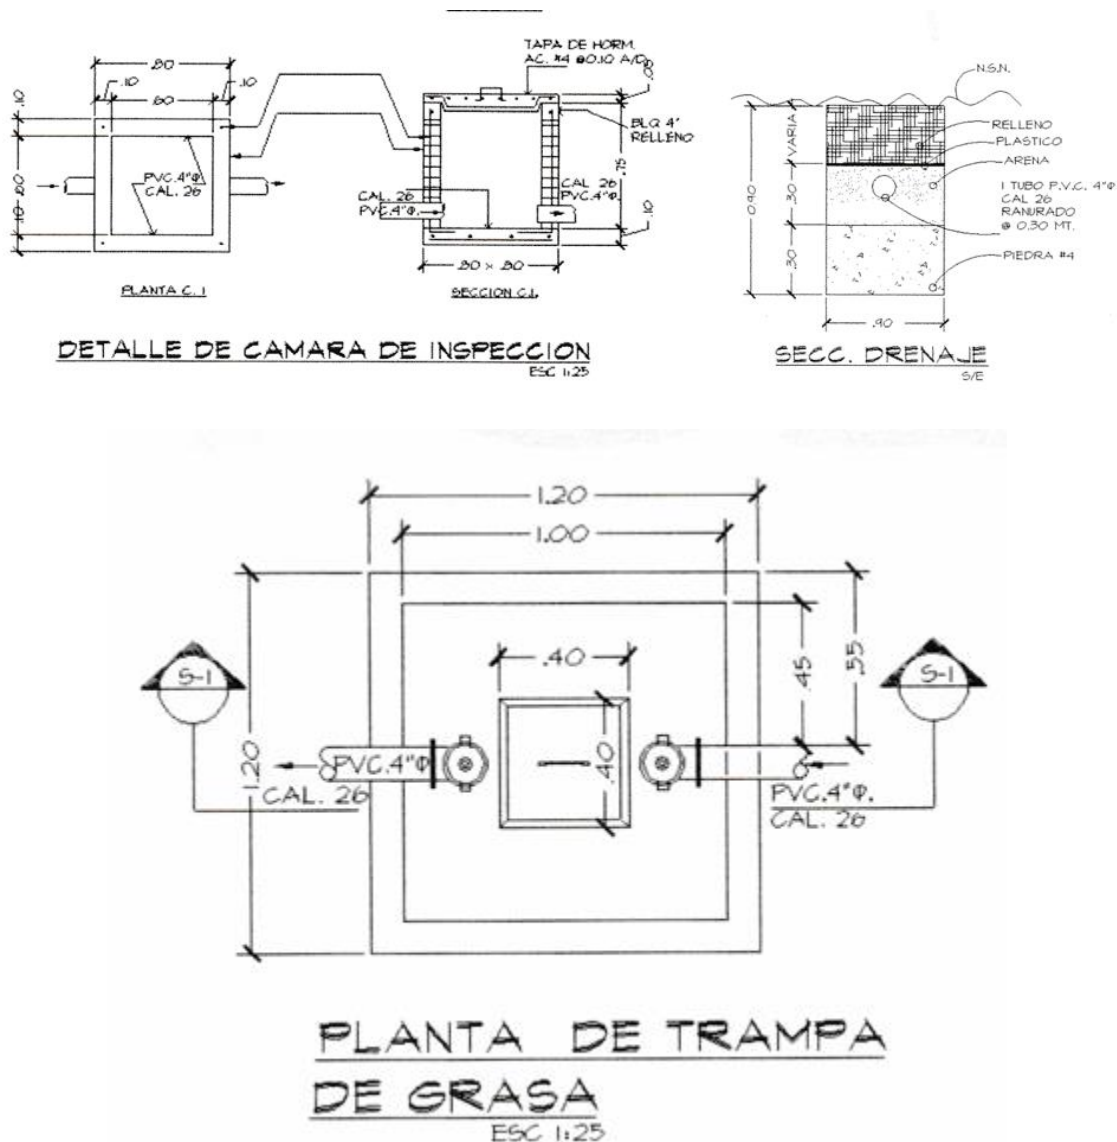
Detalle trampa de grasa, cámara de inspección y drenaje
